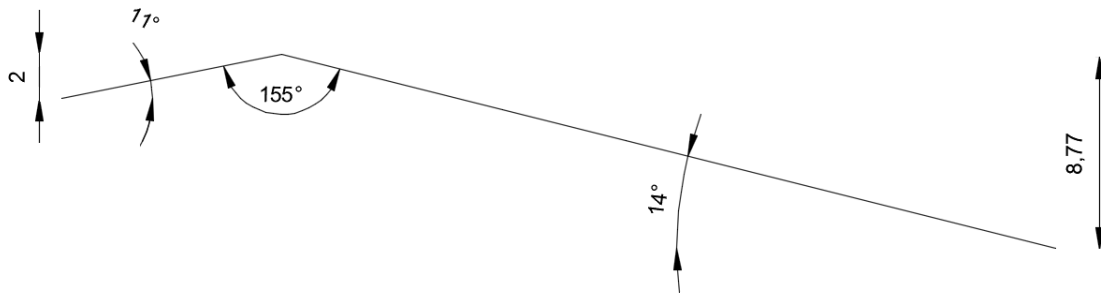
Perfil detallado de la cubierta del pabellón completo. Fuente: propia
